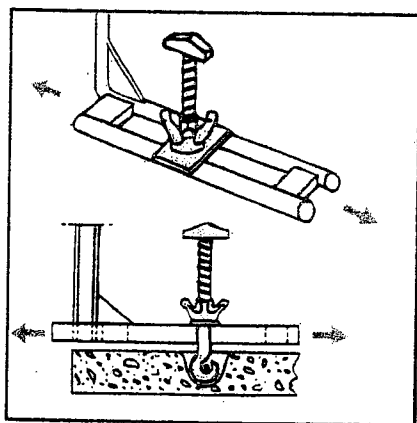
Dispositif de fixation par ancrage dans la dalle (ne doit pas être fabriqué sur chantier, mais par un fabricant spécialisé).
